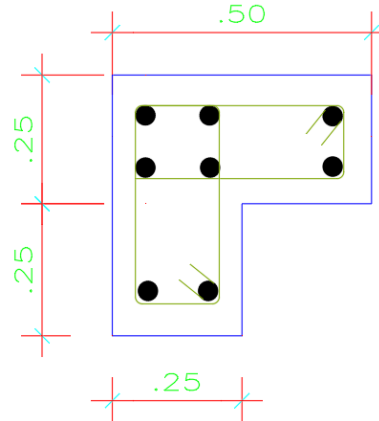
Columna en L sección 0.50 m x 0.50 m.
